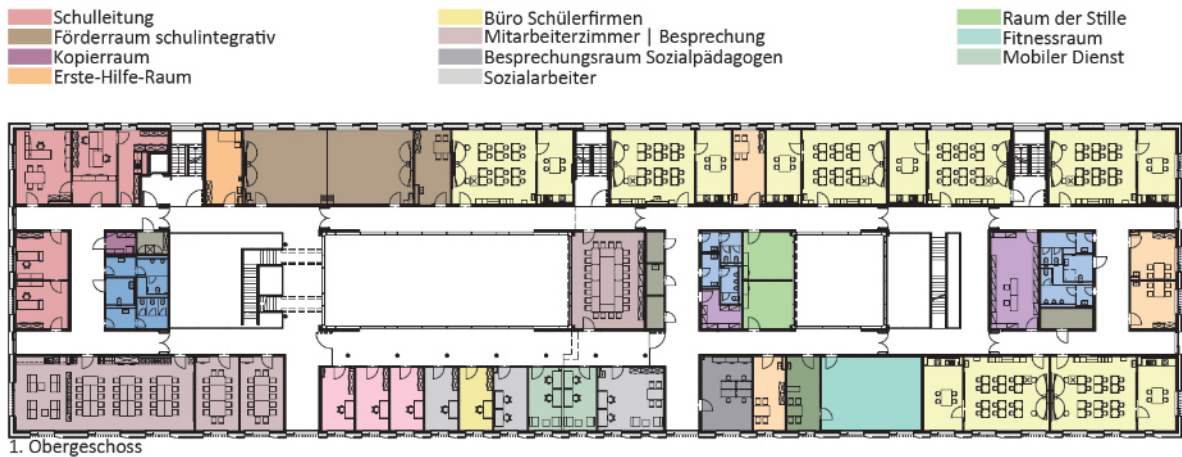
Grundriss 1. Obergeschoss
